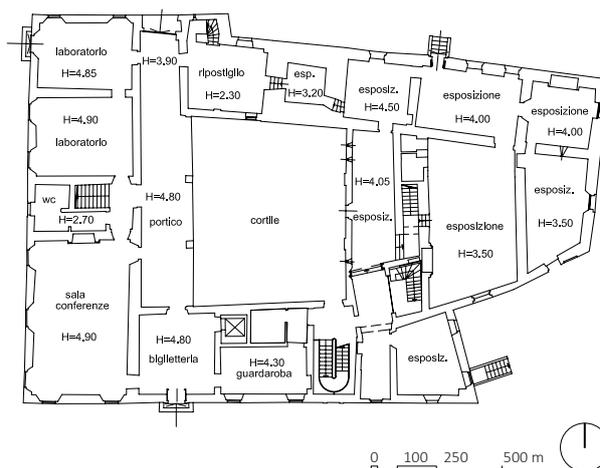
Planimetria del piano terra del Castello in cui si trova la "Sala Del Camino".
